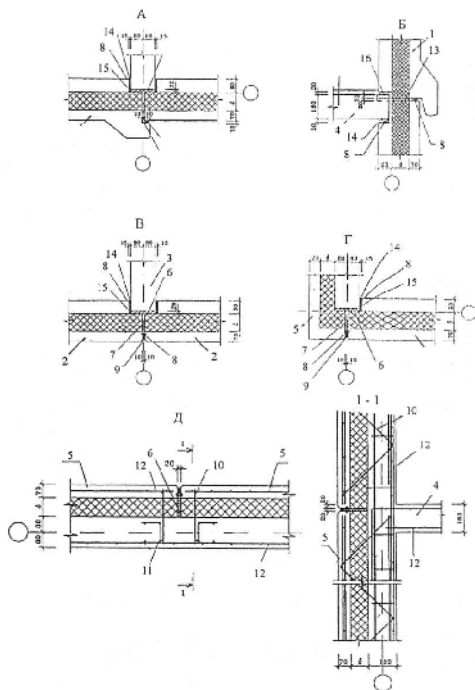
Слитые панели наружных стен зданий с монолитными перекрытиями и поперечными стенами: А – рядовой вертикальный стык трехслойных панелей продольной стены с профилированным фасадным слоем; Б – то же, горизонтальный; В – рядовой вертикальный стык панелей с плоским фасадным слоем; Г – угловой стык с несущими трехслойной панелью продольного фасада и двухслойной торцевой; Д – крепление двухслойной панели к торцевой монолитной стене: 1 – трехслойная панель наружной стены с профилированным фасадным слоем; 2 – то же, с гладким; 3 – монолитная внутренняя стена, 4 – монолитные перекрытия, 5 – двухслойная панель наружной стены, 6 – утеплитель, наклеенный на внешний торец внутренней панели, 7 – утеплитель, 8 – упругая прокладка, 9 – герметизирующая мастика, 10 – каркас навески панели, 11 – стальной арматурный каркас, 12 – арматурная сетка, 13 – несгораемый утеплитель, 14 – затирка цементным раствором, 15 – конопатка, 16 – цементный раствор
